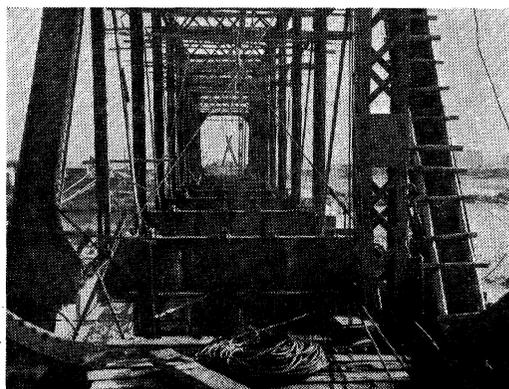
Floor Beam の中央に切断線および鉋孔をあけ、ターンバックルをつけた Sway のワイヤを取付け、Stringer を取りのぞく
